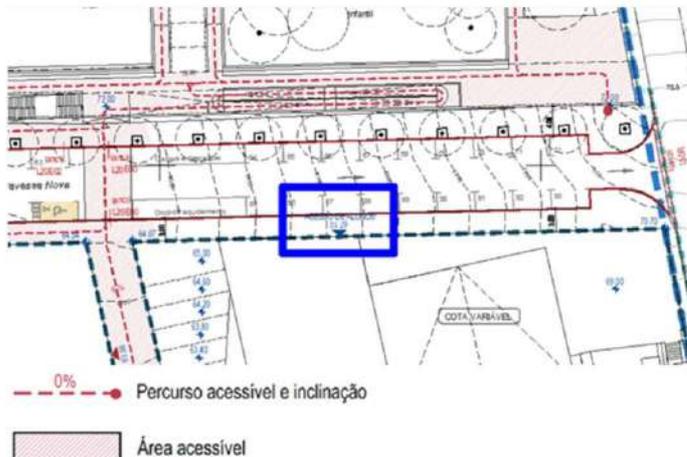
Plano de Acessibilidades - Planta Geral (desenho LOT-022 (R1), Maio 2023).
